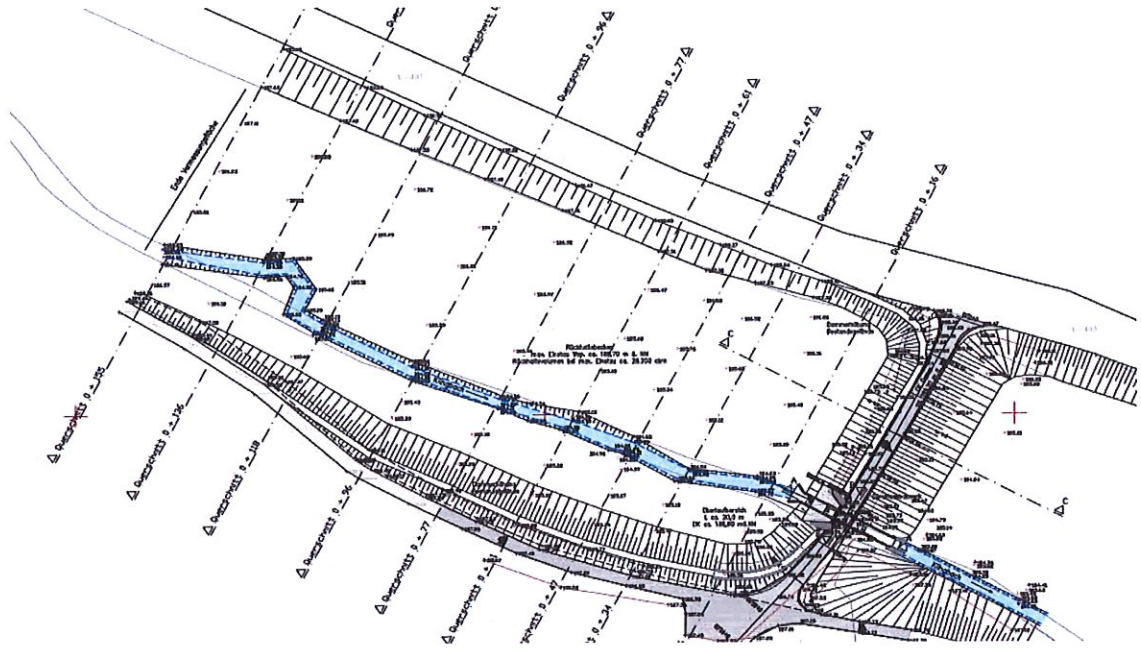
Lageplan RRB Sauteich (Auszug aus Planung RRB Sauteich)
